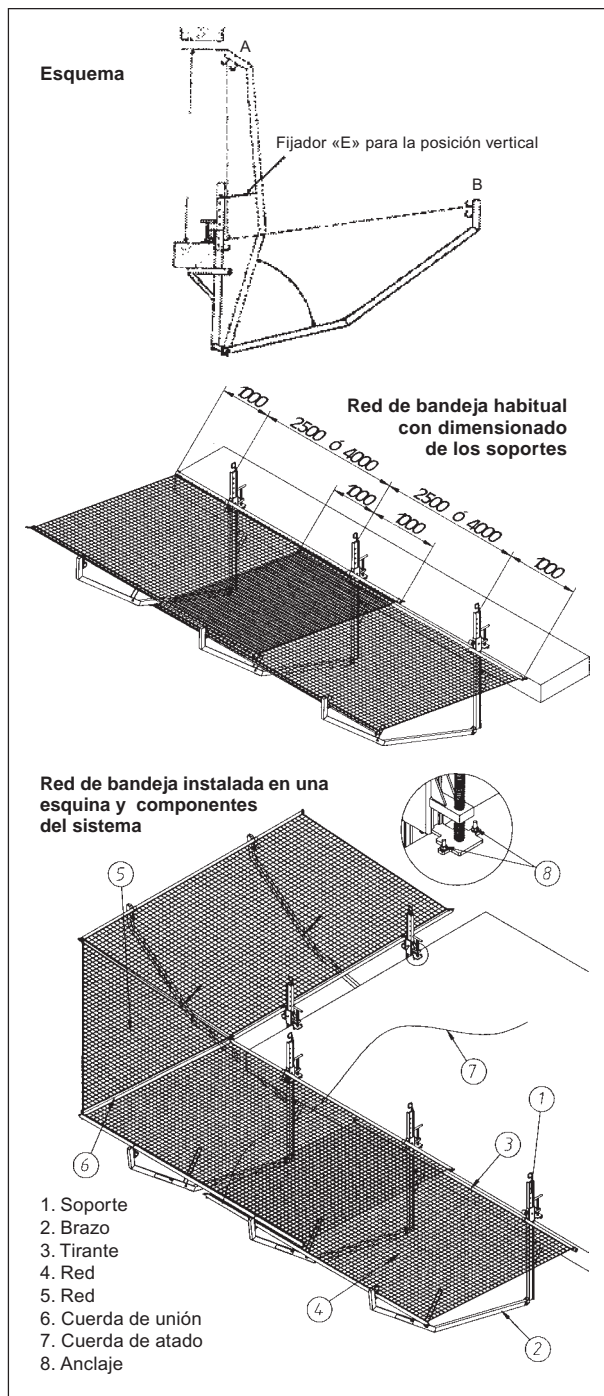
Aplicaciones de la red tipo T. Vertical y Horizontal
